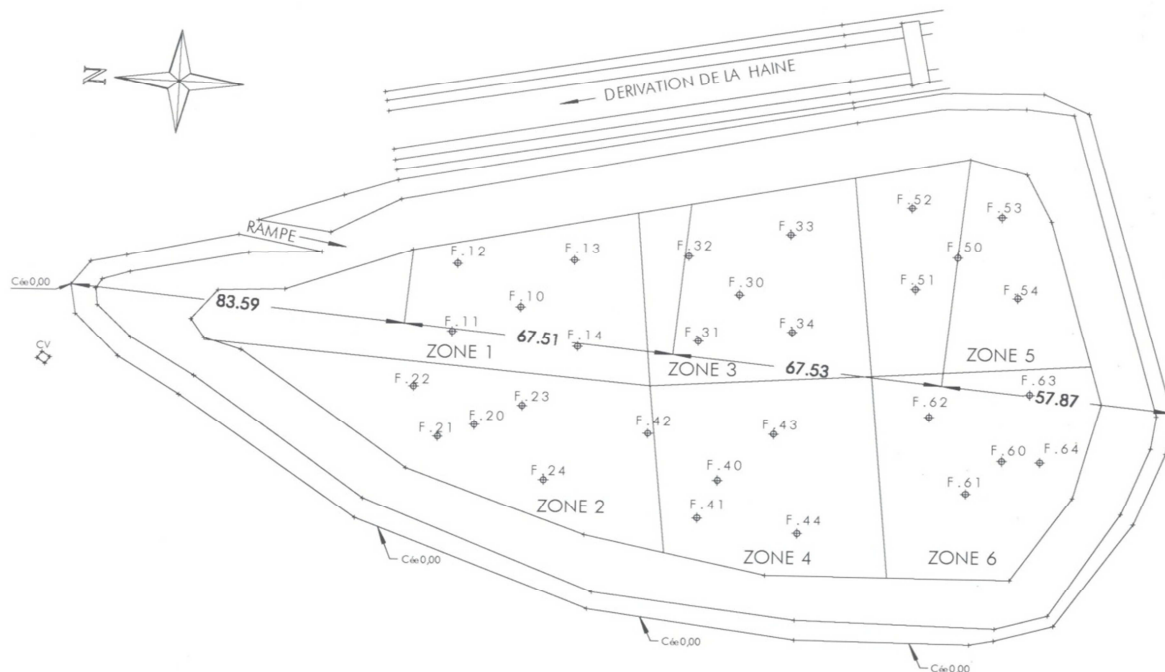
Figure VII : Plan général du site de dépôt de produits de dragage (Obourg, Belgique). Implantation des forages sur le terrain d'Obourg (n°26), Maisières (Mons, Belgique). 7 juillet 2000 (Laboratoire de Recherches Hydrauliques, Ministère wallon de l'équipement et des transports).
